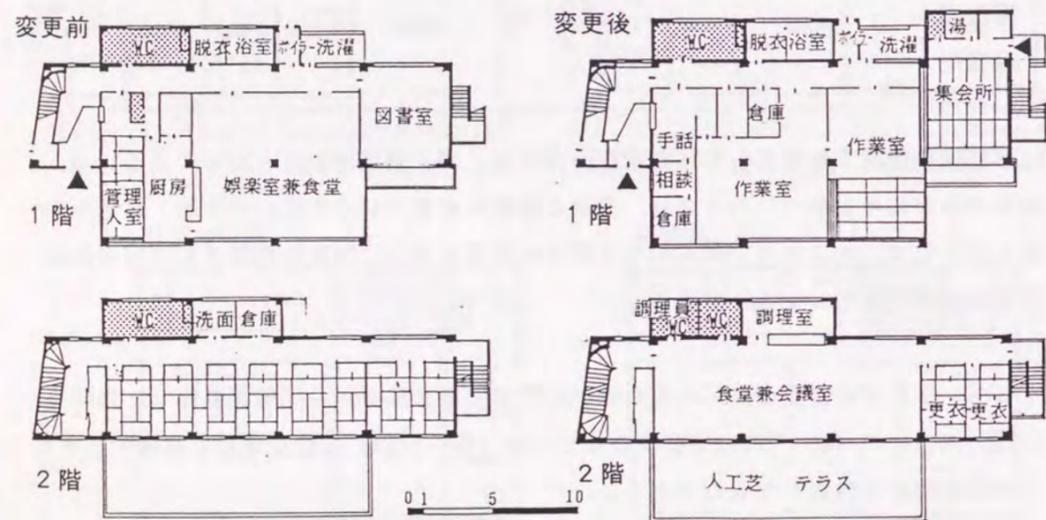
〈98〉西宮市すずかけ作業所+集会所(旧消防職員待機宿舎)1,2階平面図
